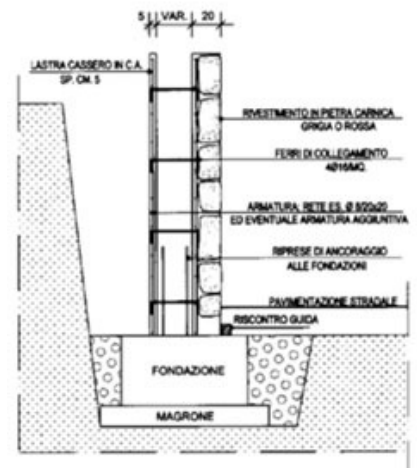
Sezione dei pannelli doppia lastra rivestiti in pietra.
